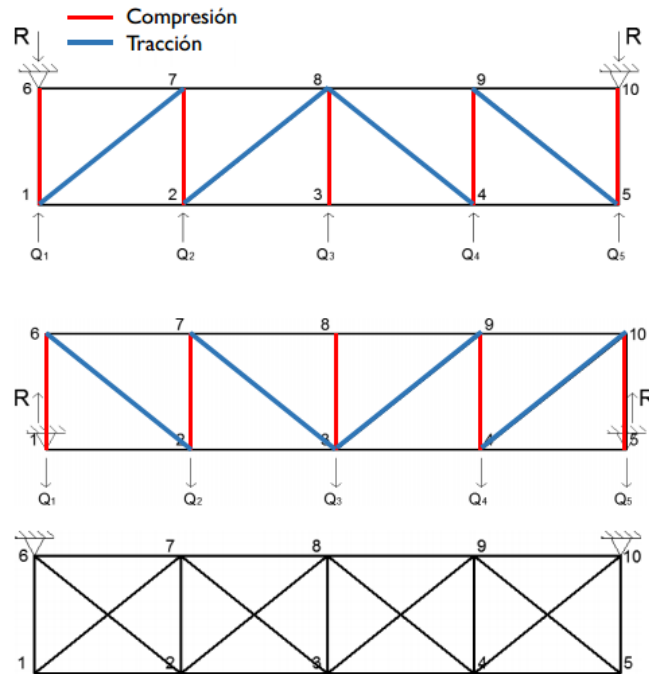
Viga contraviento tipo Pratt. [6. Construcción T8, 14/15].
